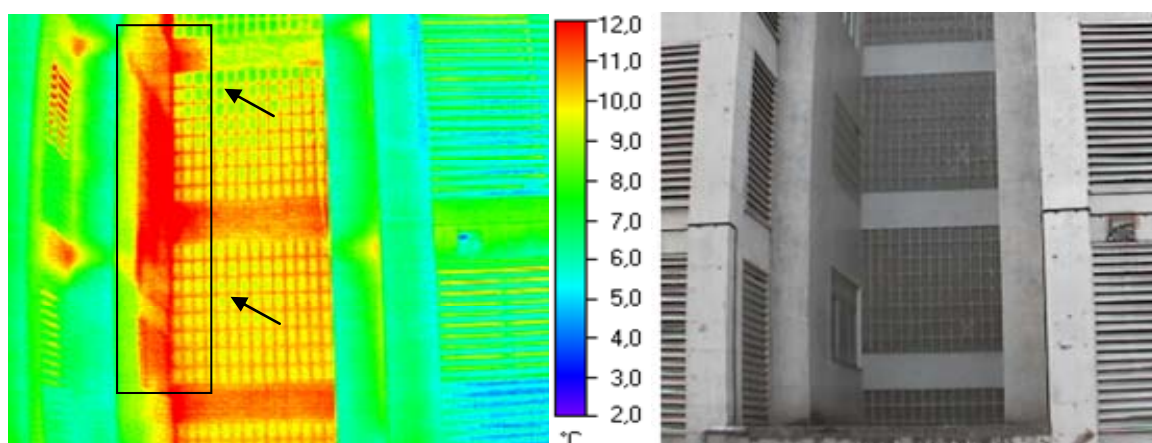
Cerramientos exteriores en las cocinas en las torres (fachada norte)
